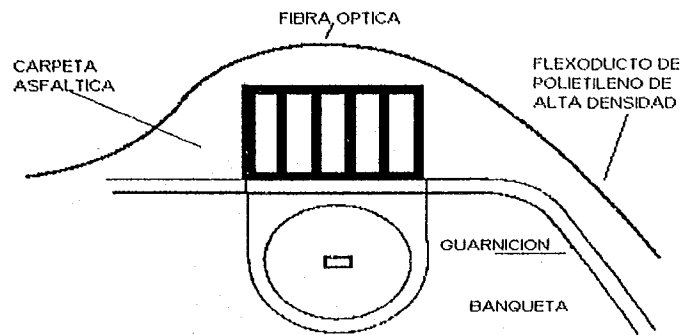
Tendido de fibra óptica sobre el pavimento a la altura de una alcantarilla
